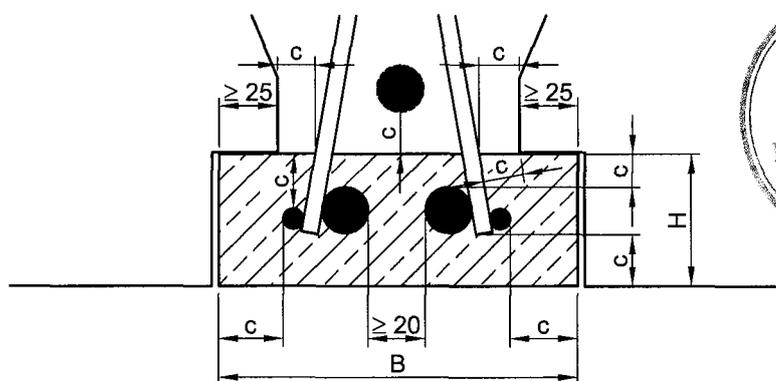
Betonfußleiste mit D-Träger und Zulagestäben
